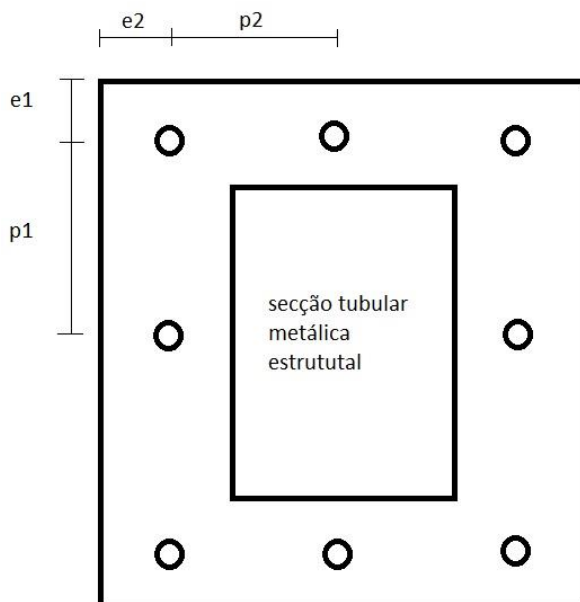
Corte superior de chapa de fundação na base do pilar de um pórtico de sinalização
